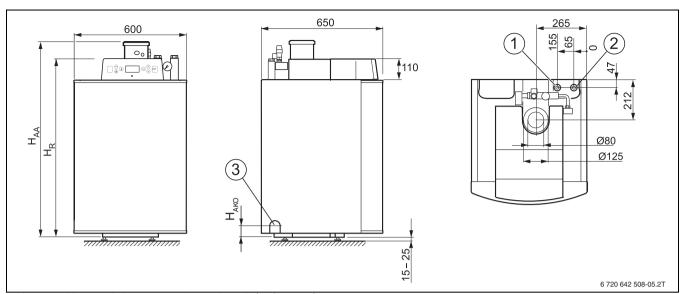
Anschlüsse und Abmessungen des Heizkessels (Maße in mm)
